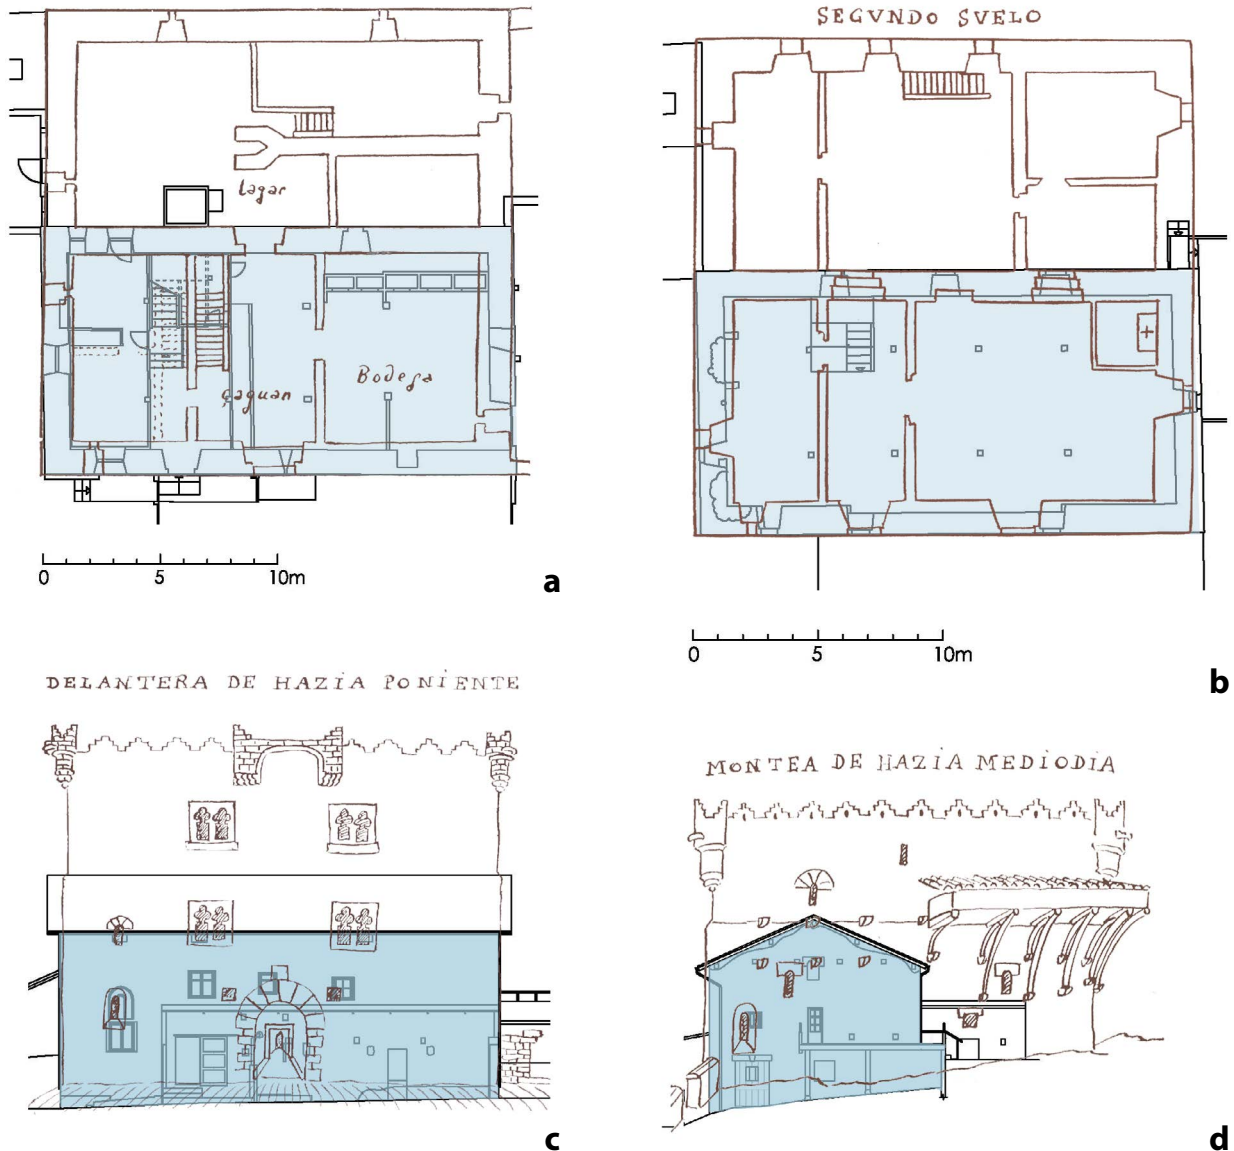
Sobreposição da planimetria atual sobre a planimetria histórica da Casa Ducal de Hajar: plantas e alçados.
